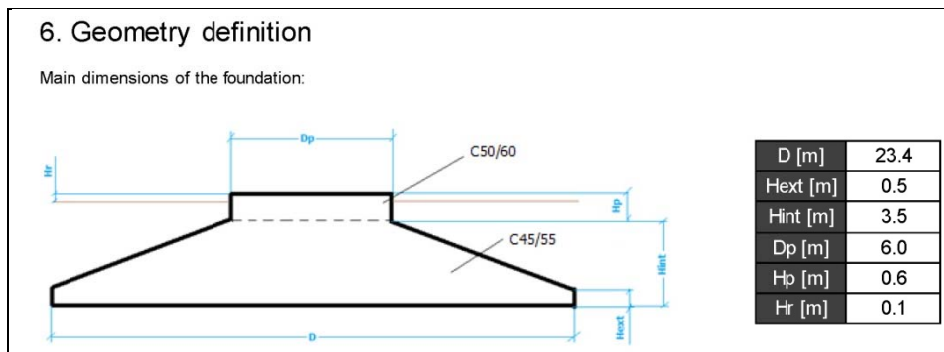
Tipico Fondazione specifica Siemens - Gamesa
